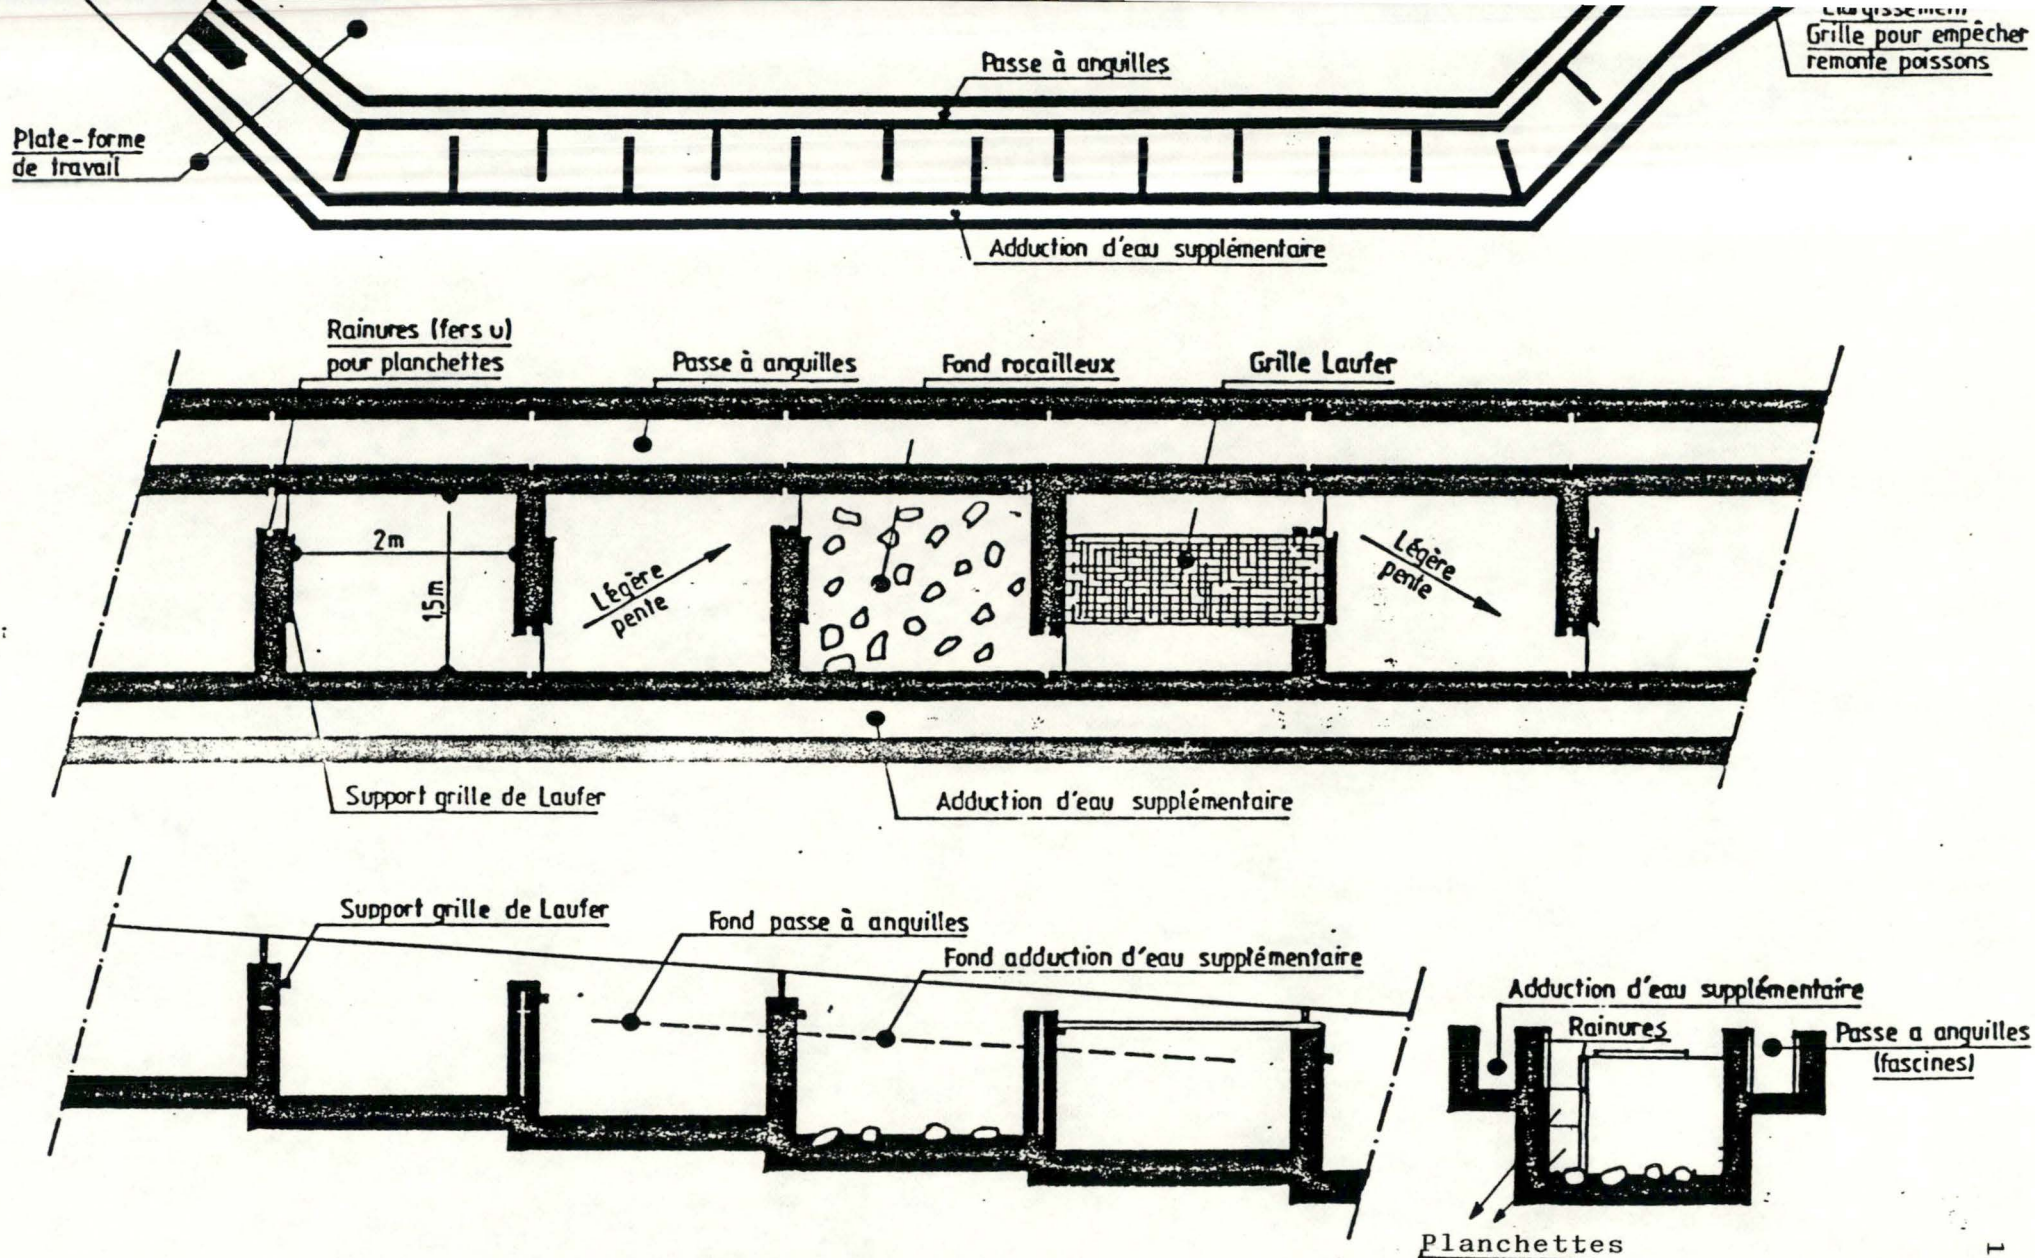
Schéma de l'échelle type gradin (ou escalier) avec passe ou goulette à anguilles
